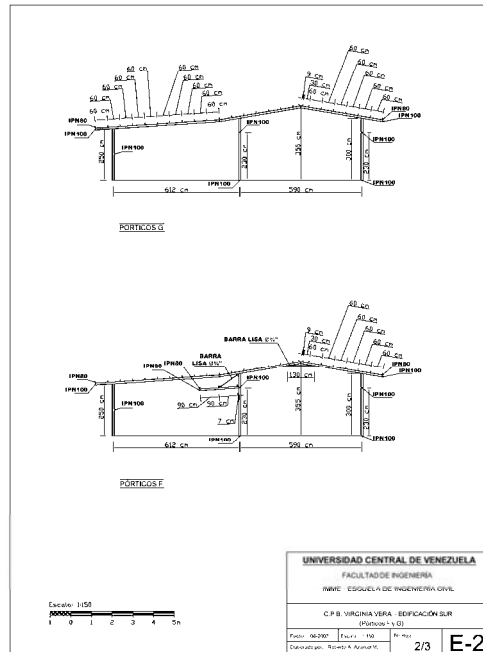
Plano E2: Plano Estructural de los pórticos F y G
